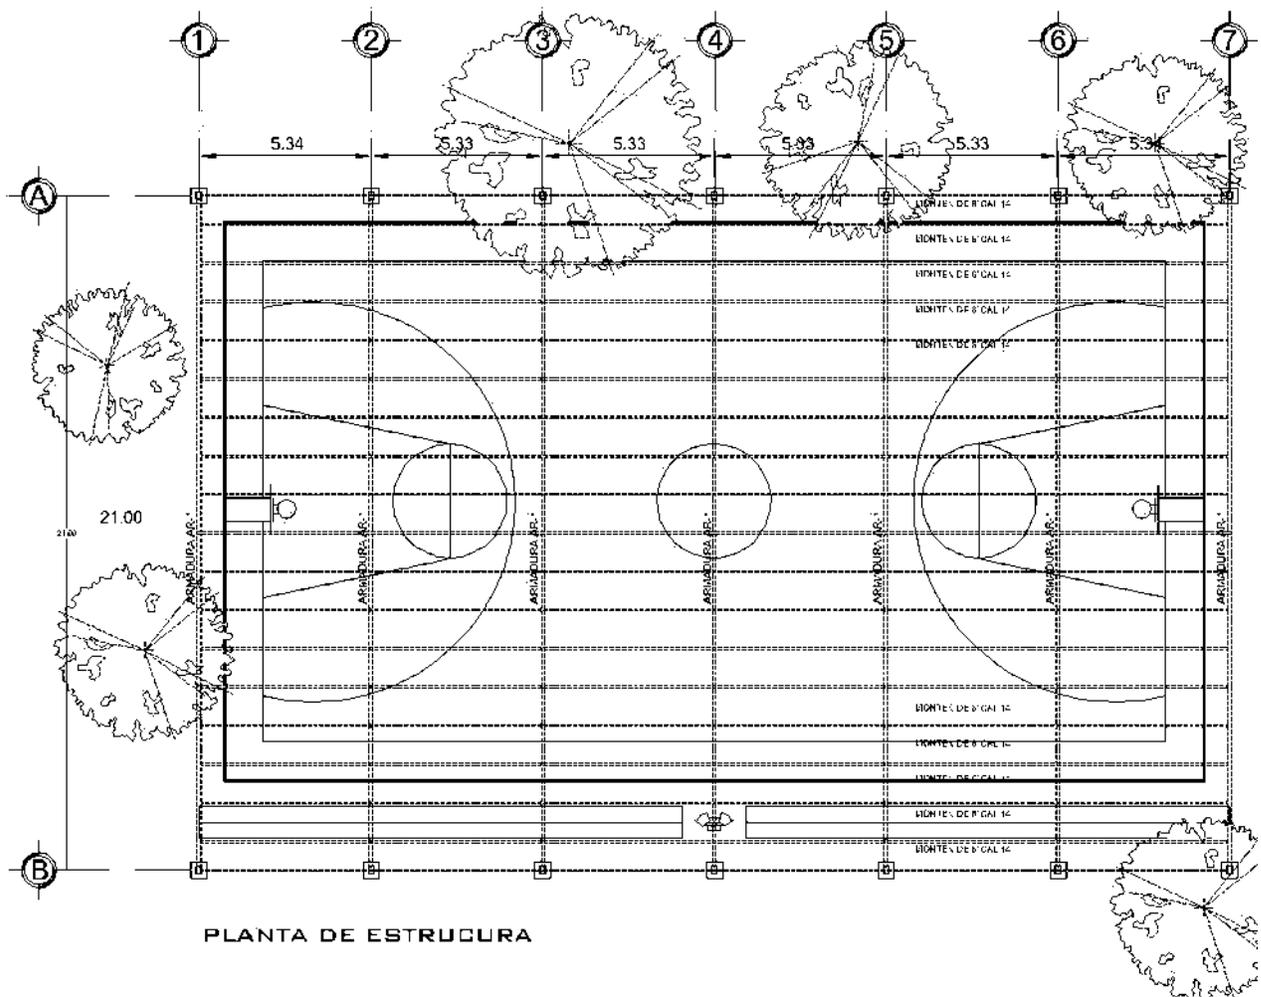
Estructura vista en planta, dibujo en Auto CAD.
